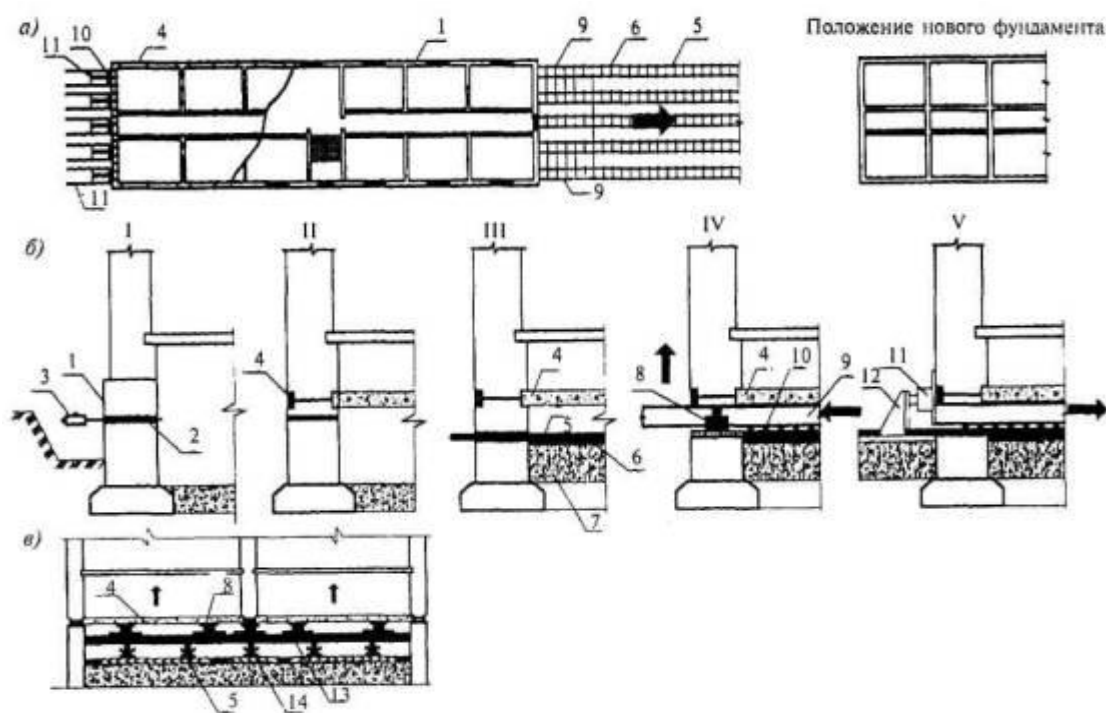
Технологические этапы подготовки к передвижке и перемещению здания
